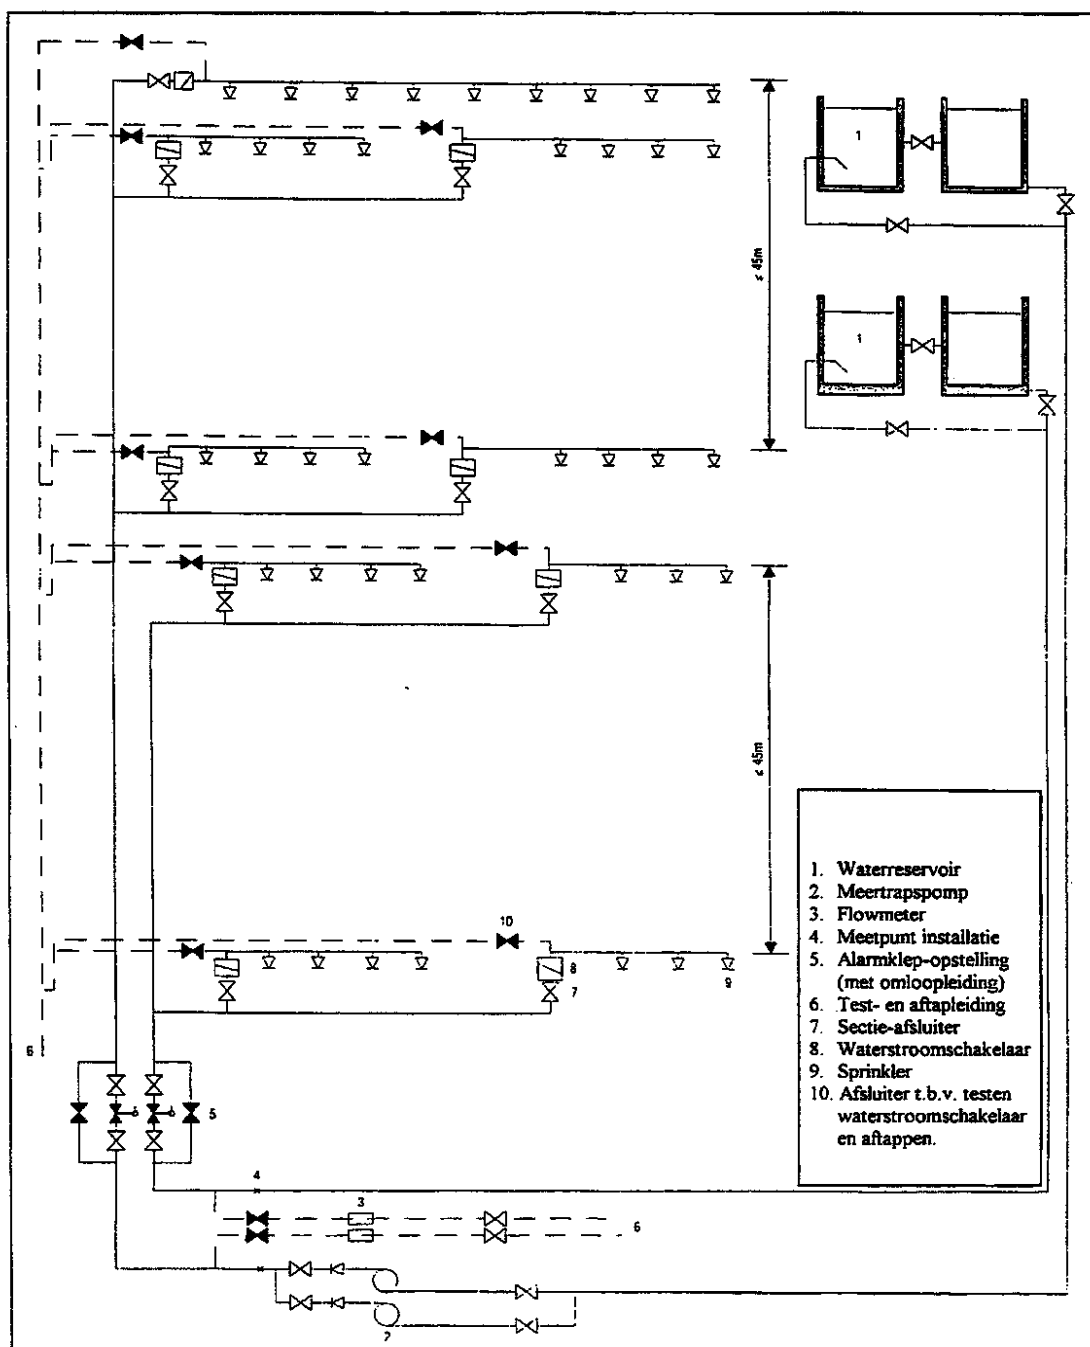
Voorbeeld van een sprinklerinstallatie en watervoorziening bij hoge gebouwen.
